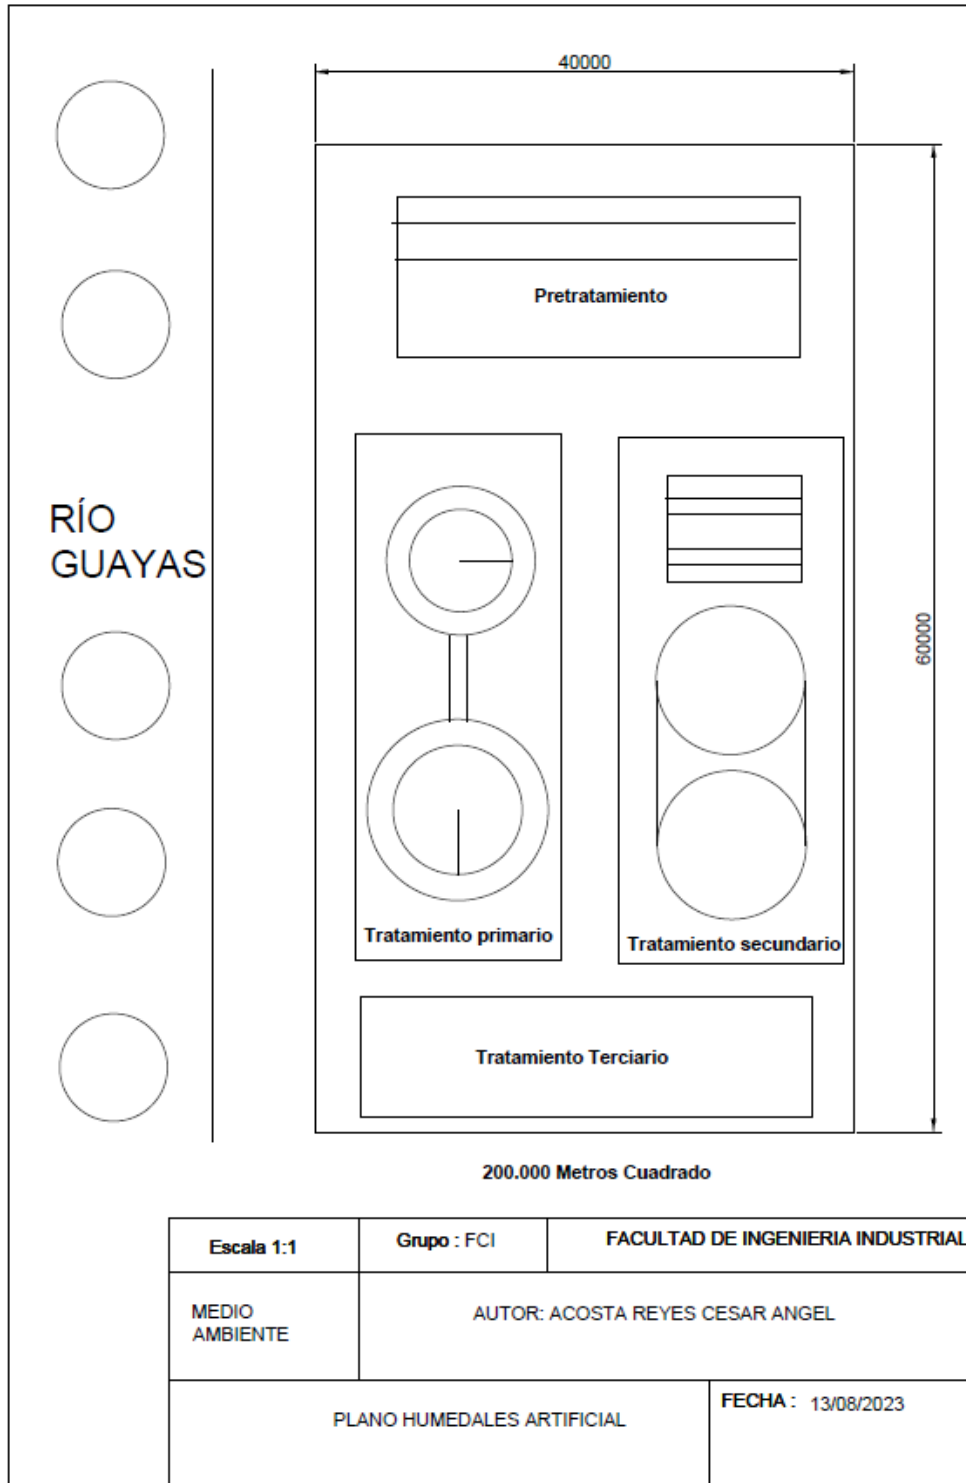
Plano de propuesta planta de tratamiento de aguas residuales. Elaborado por el Autor.
